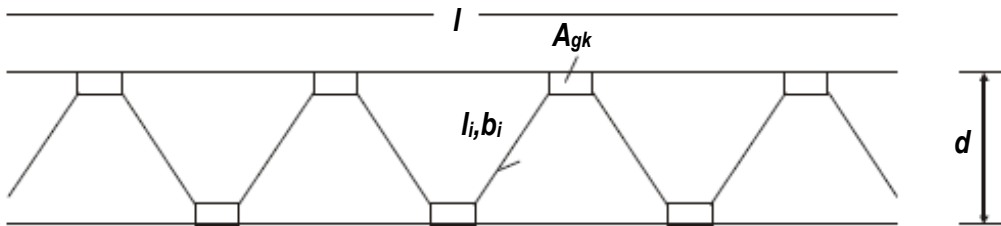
Estruturas Treliçadas [adaptado EC3]
